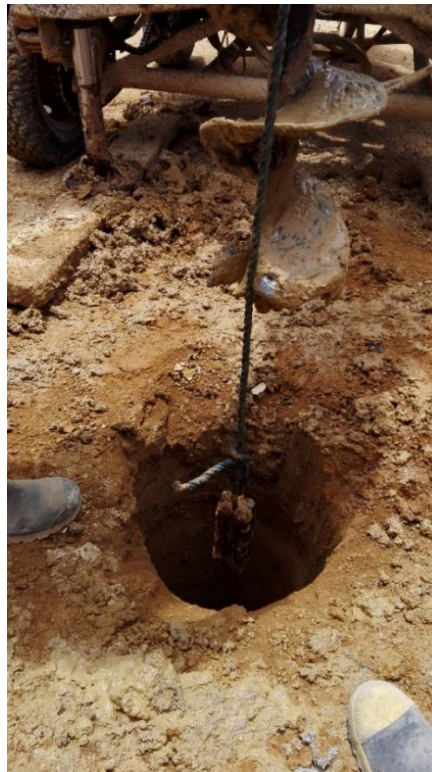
Piloteadora barreno helicoidal. Fuente: Tomada por el pasante
